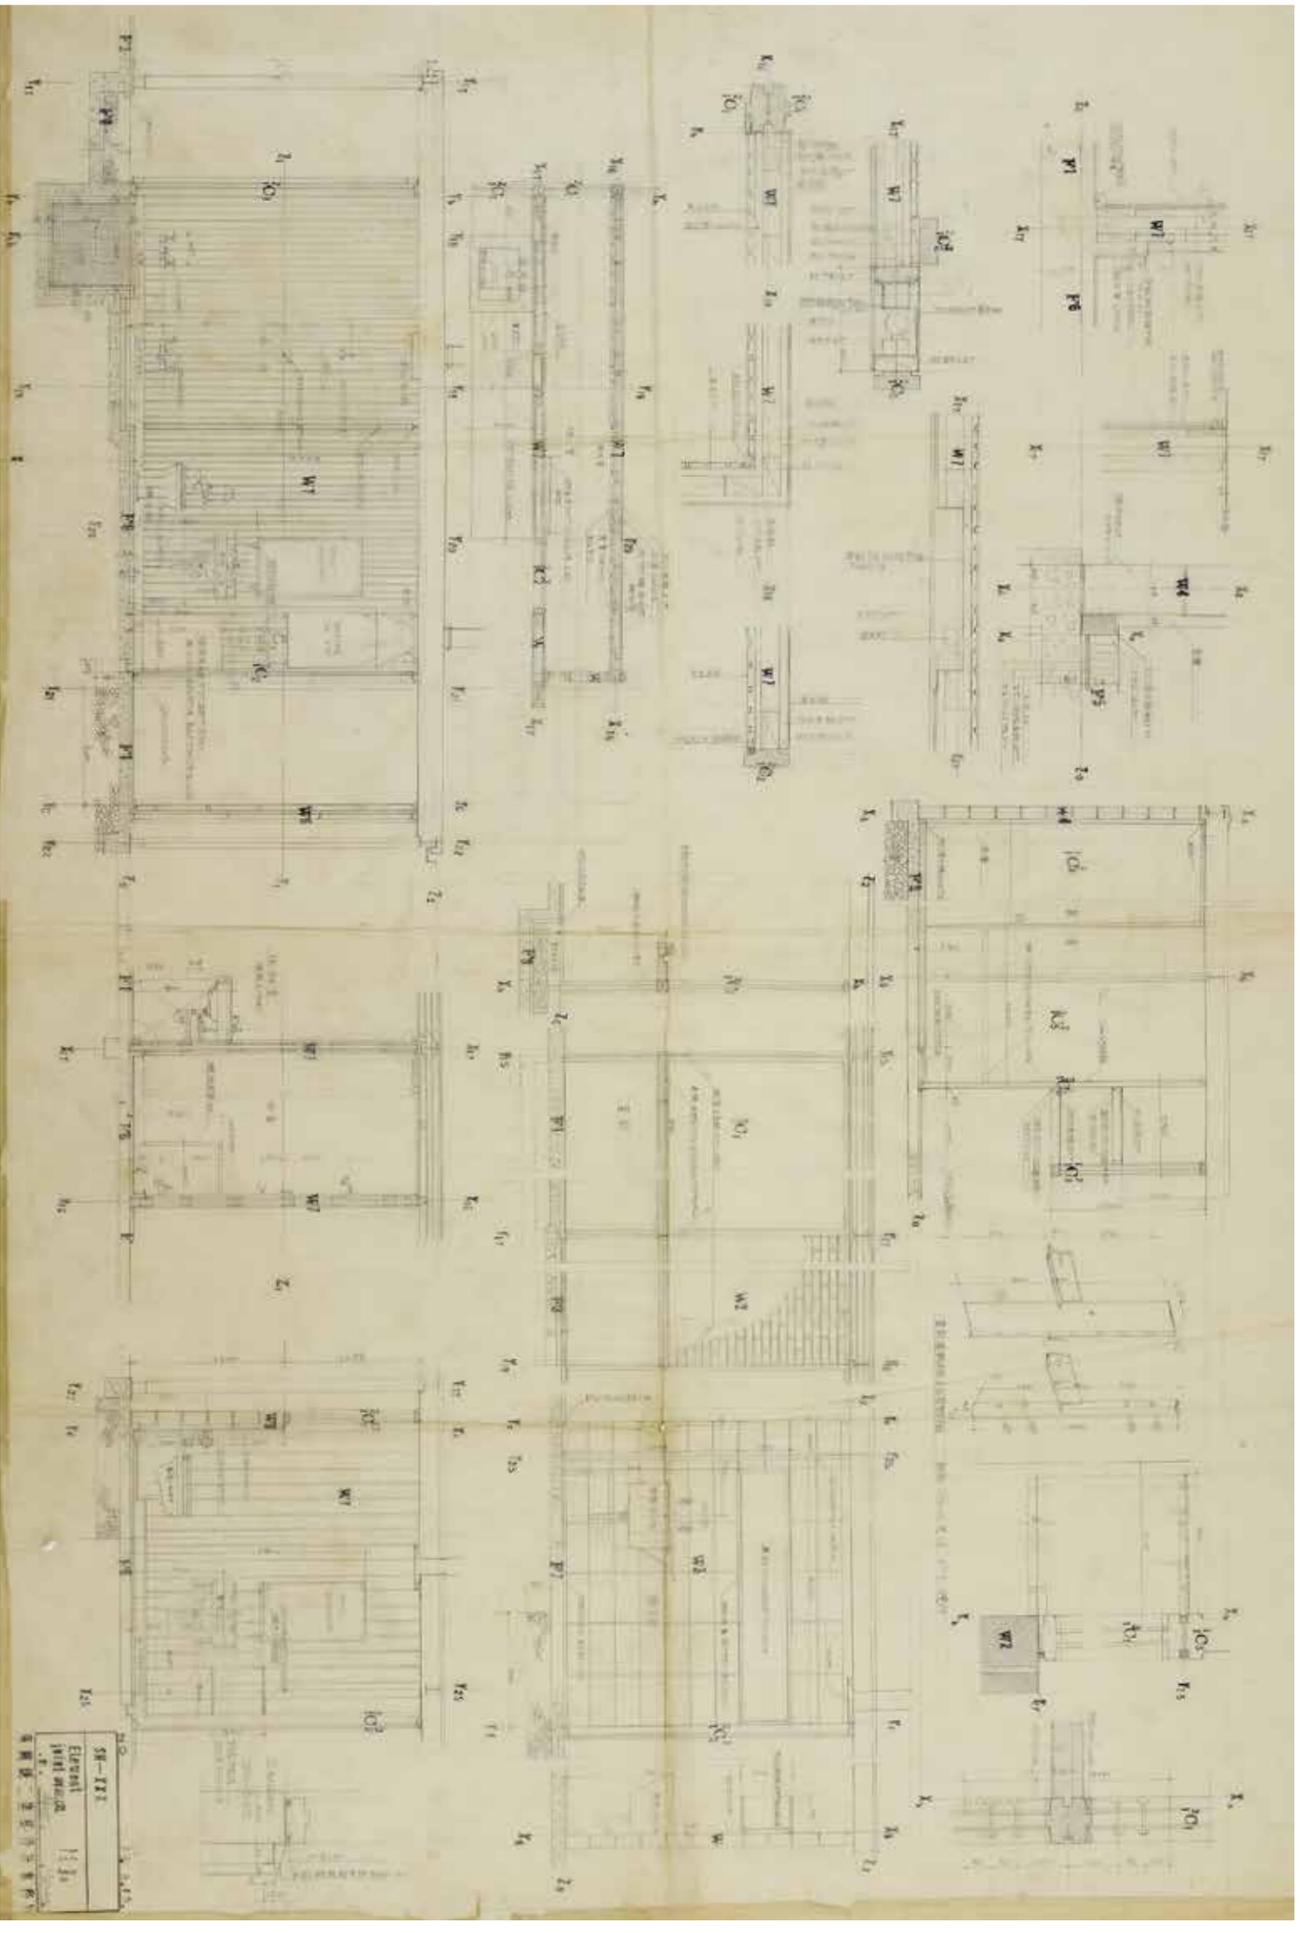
(上図) / ELEMENT JOINT 詳細図 (断面詳細図)
